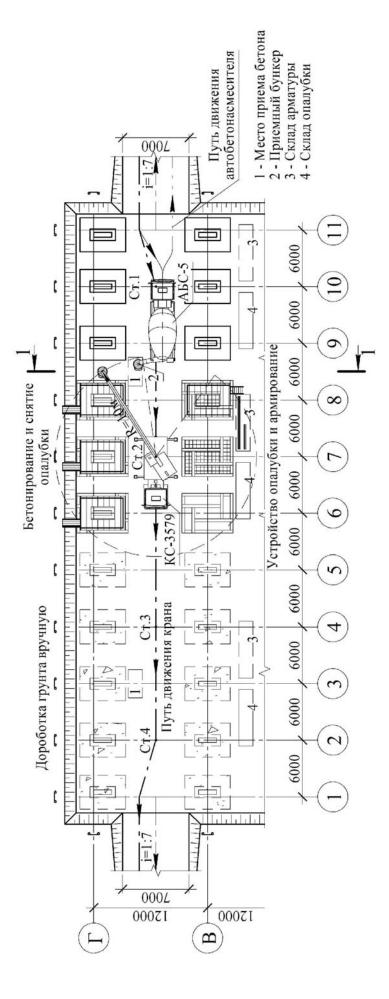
Схема организации работ по устройству монолитных столбчатых фундаментов в котловане
